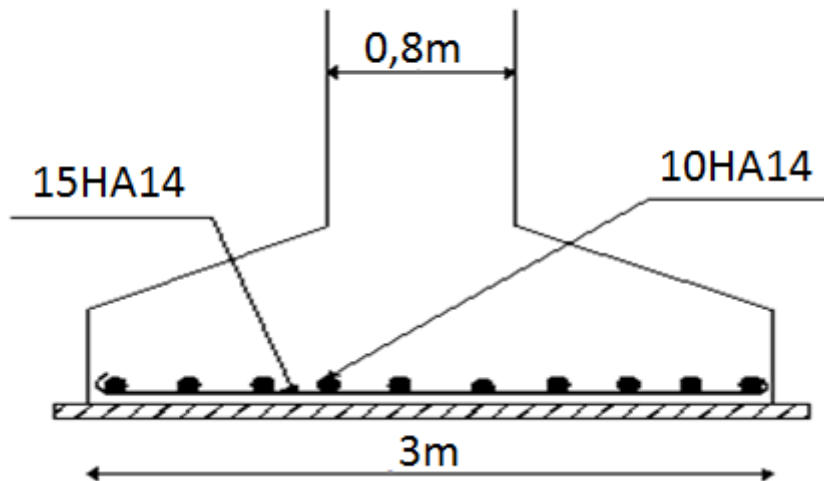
Schéma de ferrailage de la semelle type 1.
